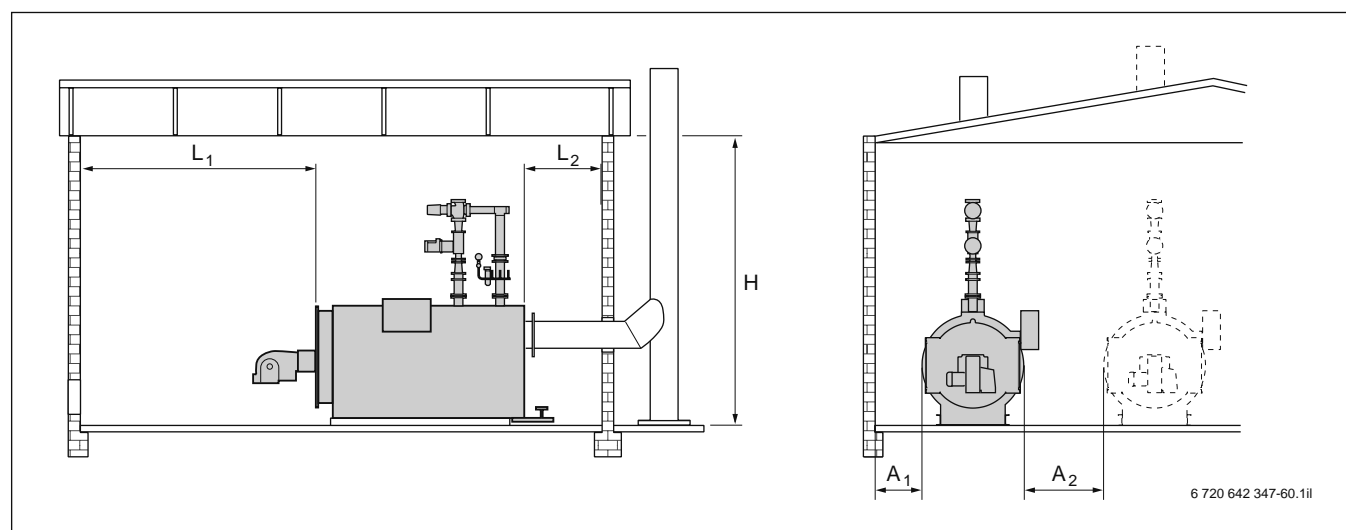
Размеры помещения для установки отопительных котлов UNIMAT UT-L
